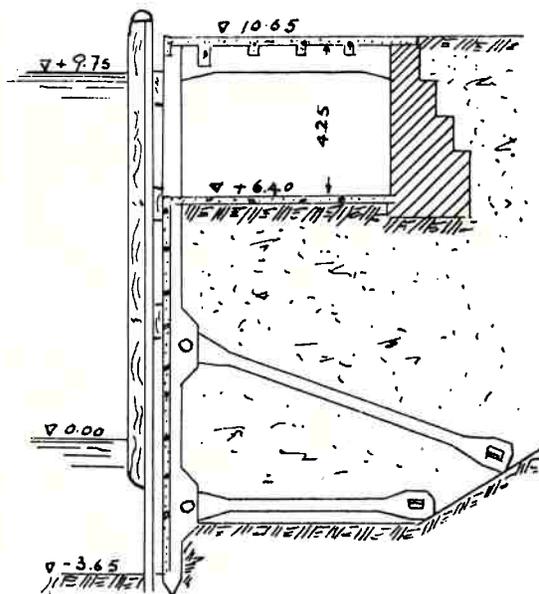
Tipo de muralha de estacas pranchas Coignet-Ravier no porto St. Peter-Gernesey.
